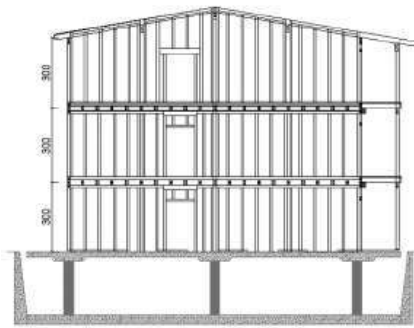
Aislación sísmica en estructuras de madera en L'Alquila.
